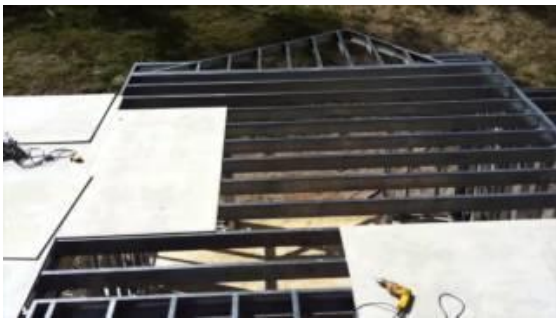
Las láminas de fibrocemento utilizadas como tablero de piso pueden tener espesores de 20, 22 y 25 mm dependiendo de la separación de las viguetas de soporte.
